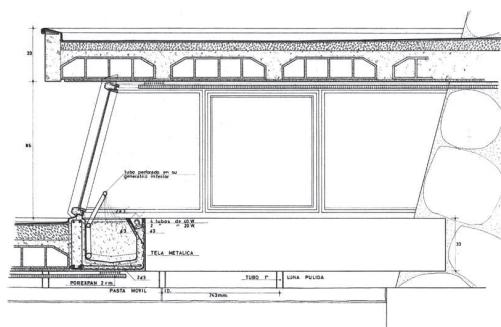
Casa Vázquez. Detalles constructivos. Plano 4. Delineado en 1963. (Archivo X.B.B: proyecto nº 57).
